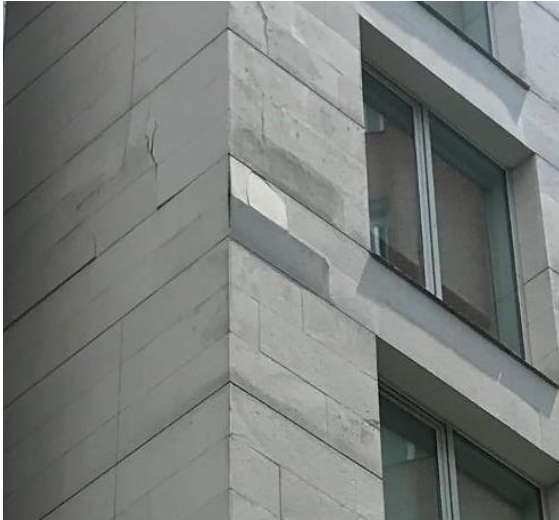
Detalle vista exterior deterioro de abombamiento y grieta en enchape.
